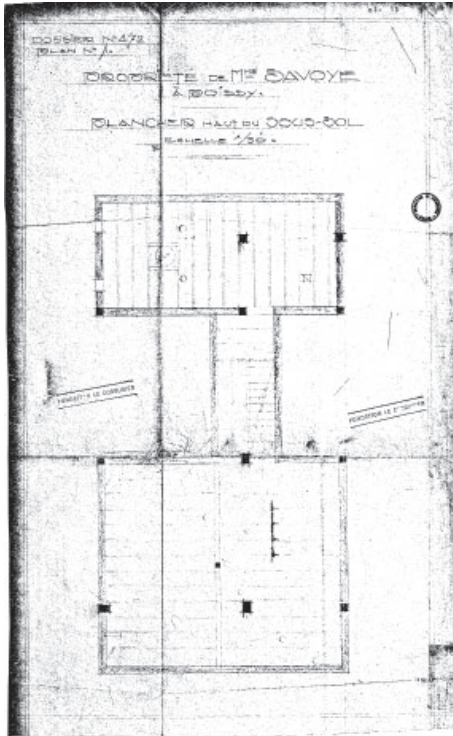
"DOSSIER N° 472 / PLAN N° 1 / PLANCHER HAUT DU SOUS-SOL" de la Villa Savoye a escala 1:50, Summer. FLC H1 (13) 296.
